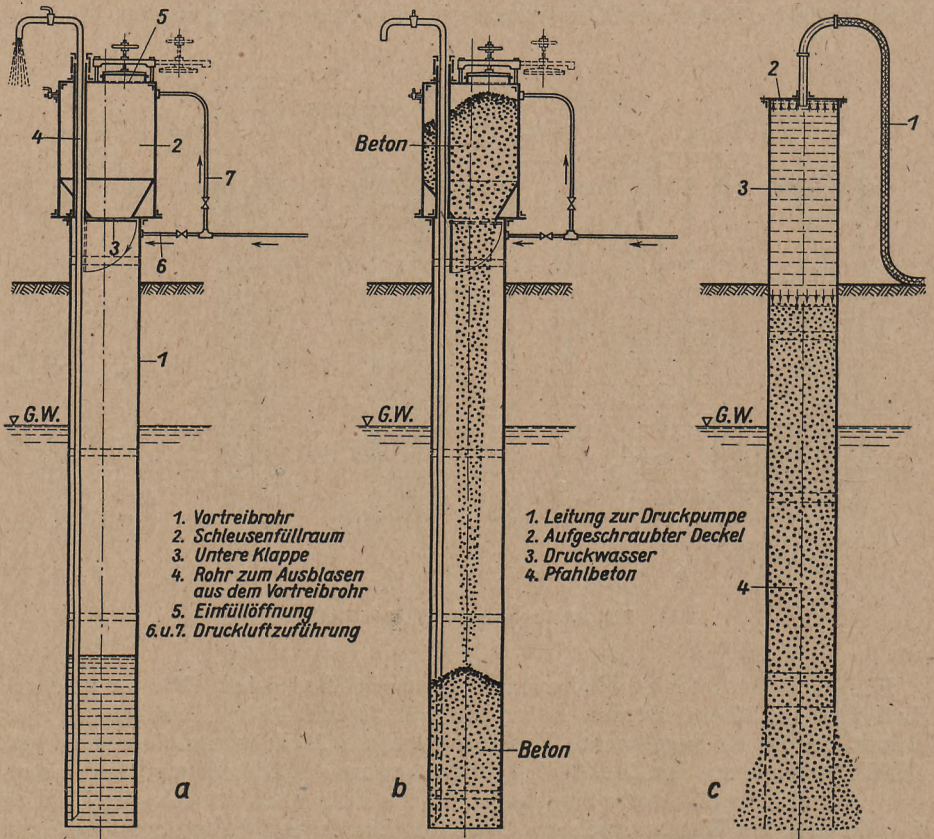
Preßbetonpfahl System Grün & Bilfinger
